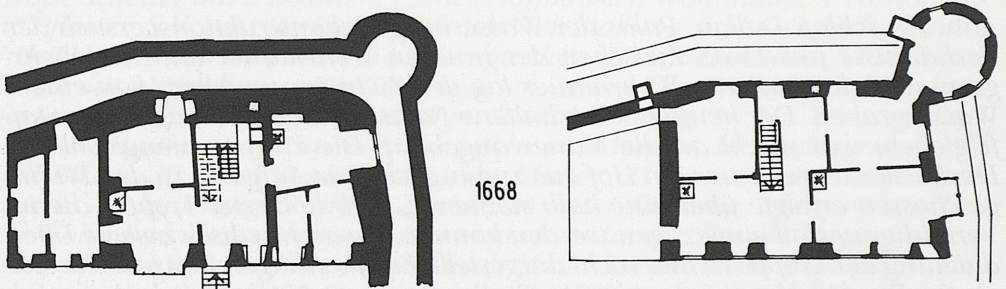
Schloß Dallau. Grundrißdisposition des ersten und zweiten Obergeschosses im Jahre 1668.
